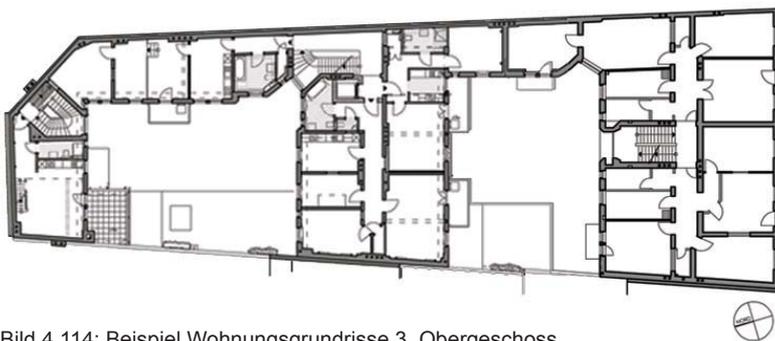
Beispiel Wohnungsgrundrisse 3. Obergeschoss
